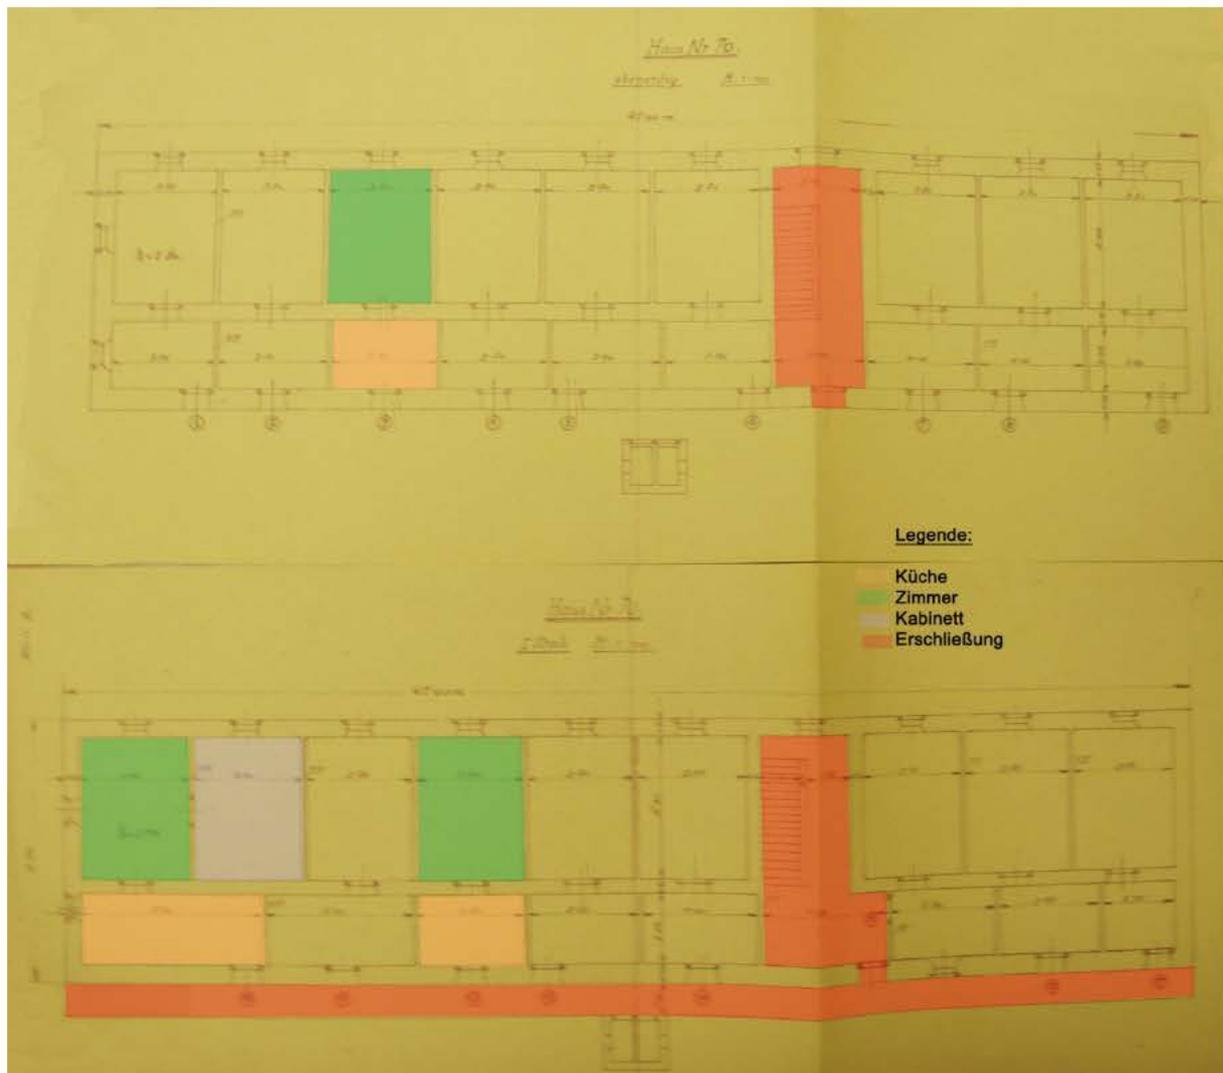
Grundrisse EG und 1.Stock des langen Hauses
